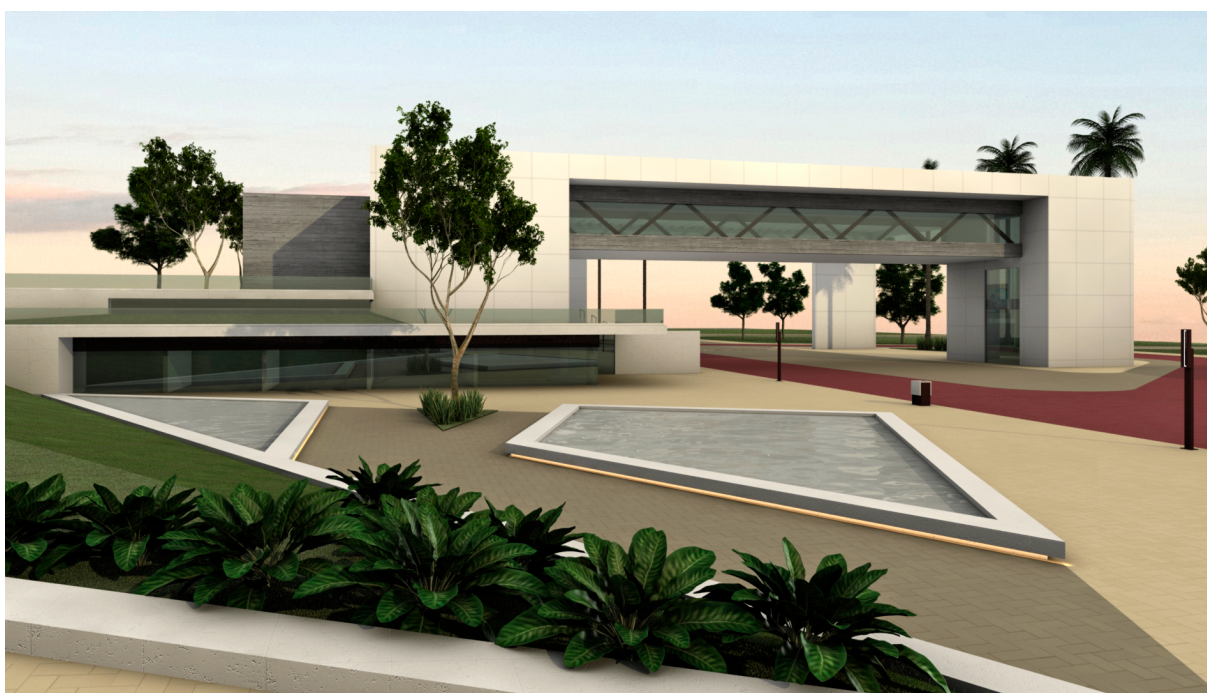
Fachada frontal do projeto, com a cobertura recuada..
